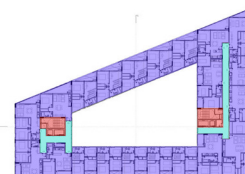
Planta nivel 4. Fuente: Archdaily, 2018.
